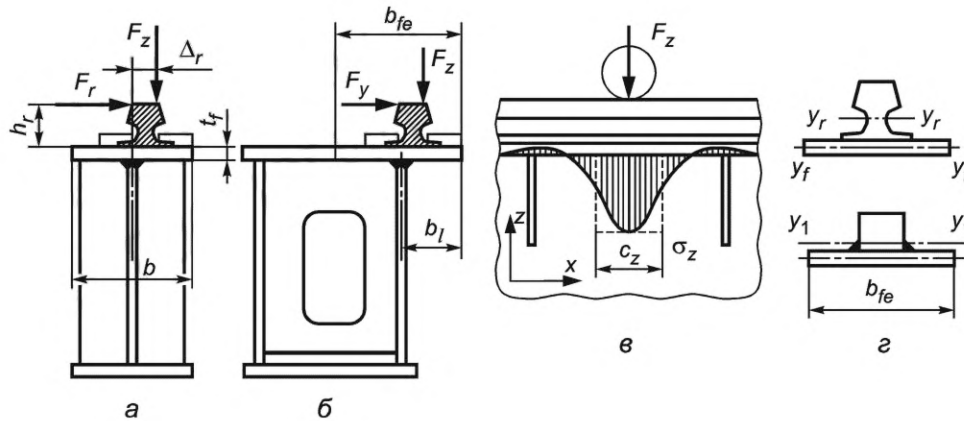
Схемы к расчету ездовых балок с рельсом над стенкой
